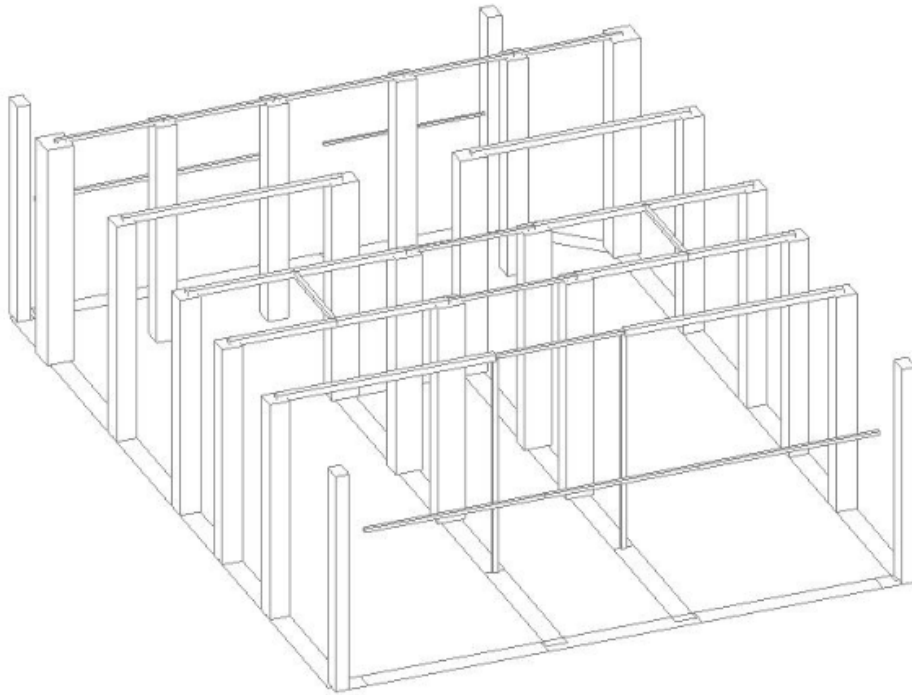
Modelado de vigas. (Fuente: Elaboración propia)
